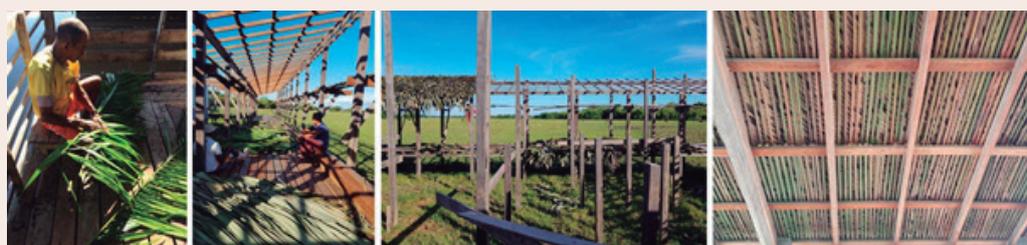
Saberes tradicionais: Telhado de palha. Alto Cururu - Chaves - PA.
